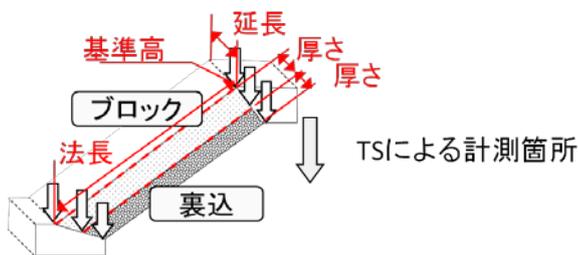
コンクリート張護岸の施工管理基準とTS測定箇所
